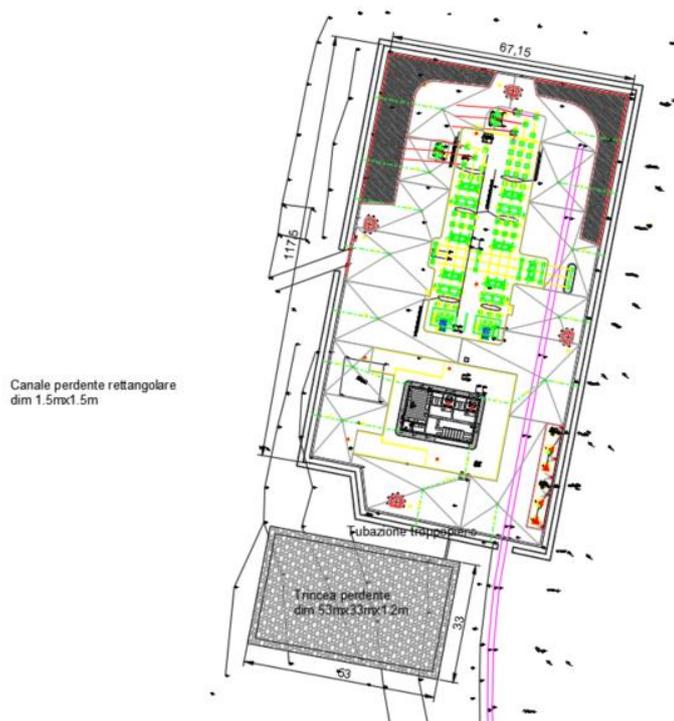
Stralcio planimetrico degli interventi di compensazione.
